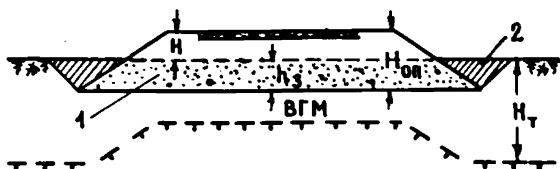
Замена грунта в основании насыпей высотой менее оптимальной и на нулевых местах: 1 - грунт замены; 2 - местный грунт
